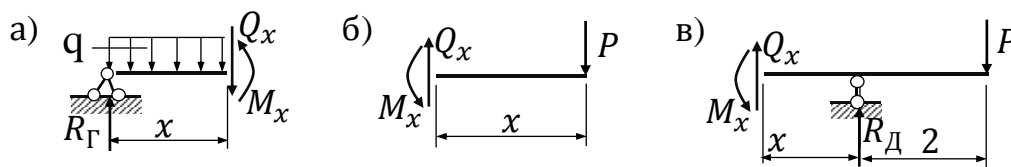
Расчетная схема для определения  $M_x$  1-го, 2-го и 3-го участков балки ГЕ.
